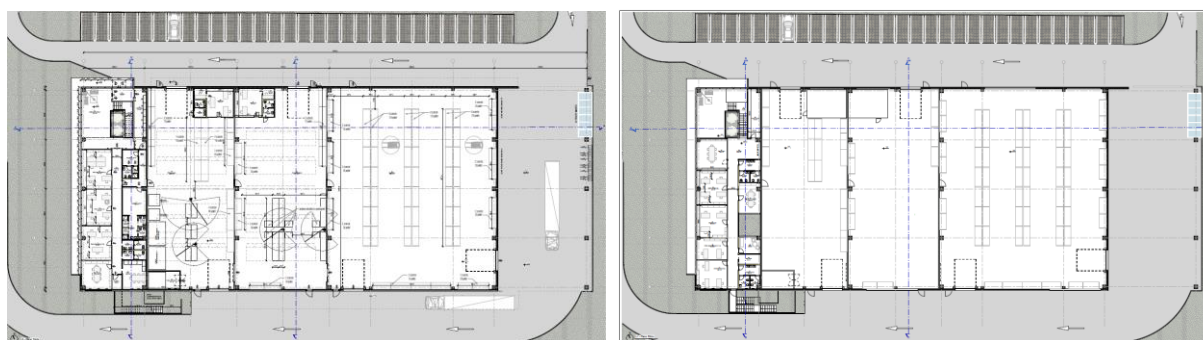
Piante interne del capannone di progetto: PT in alto e P1 in basso
